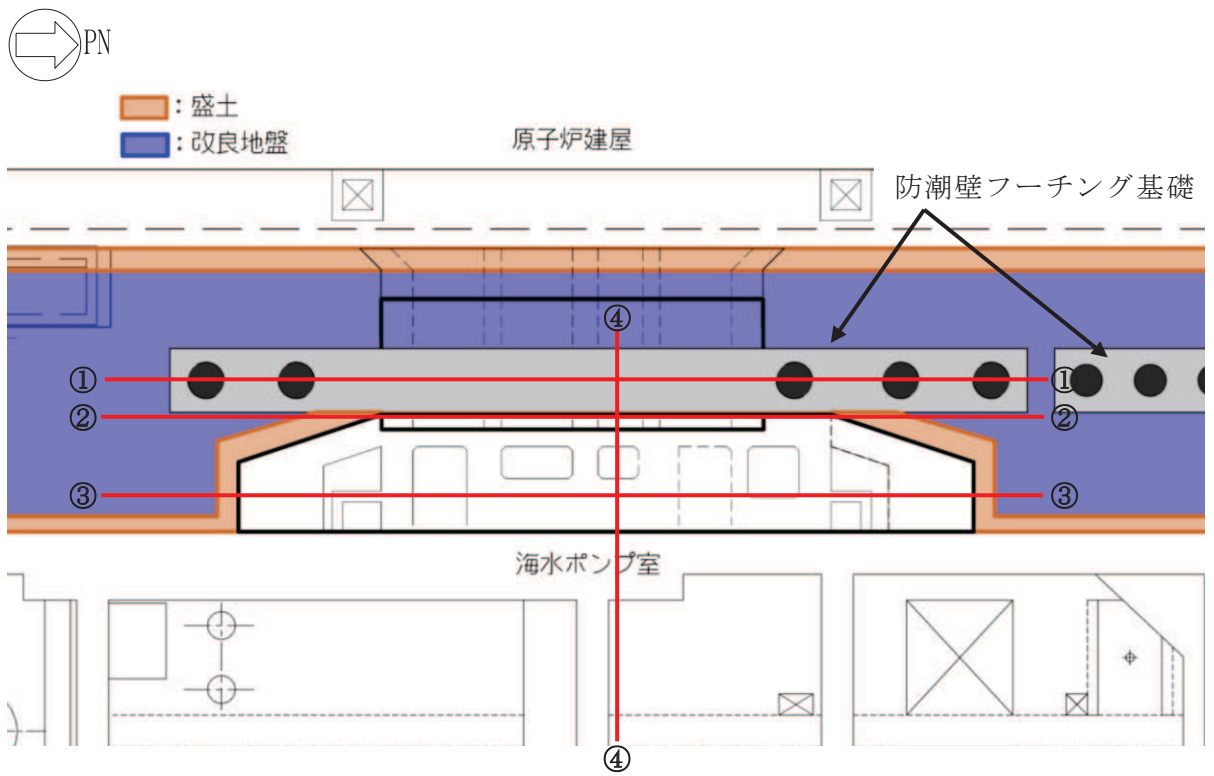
海水配管ダクト（鉛直部）周辺 平面図
